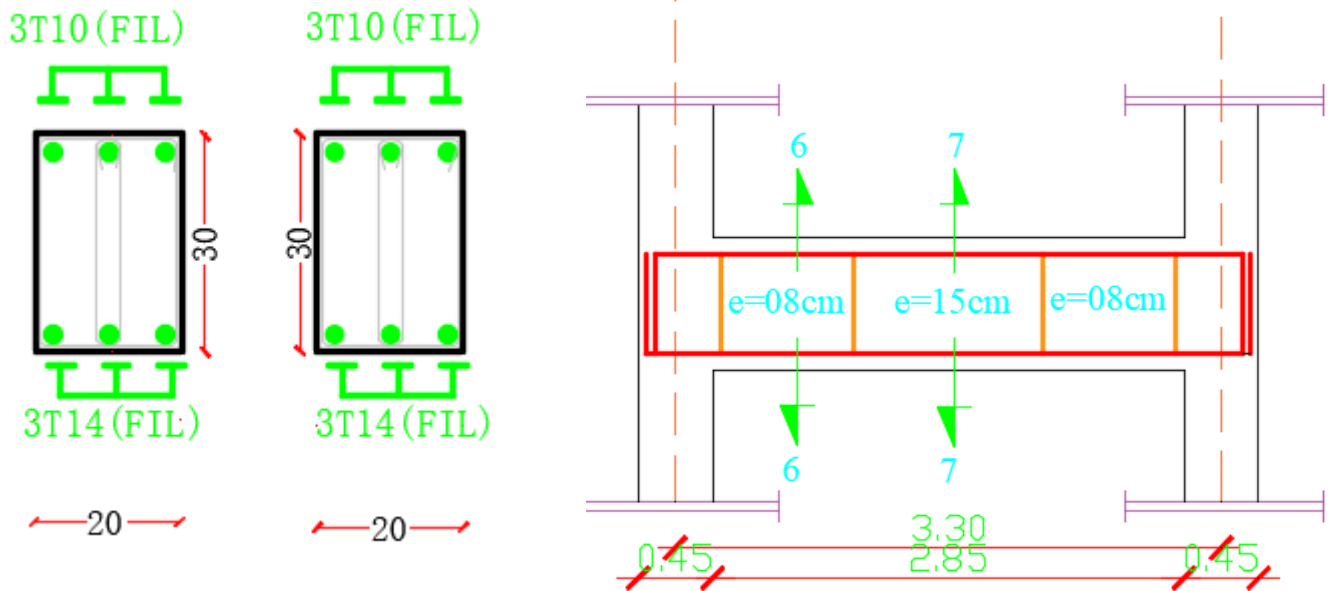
Schéma de ferrailage de la poutre palière
